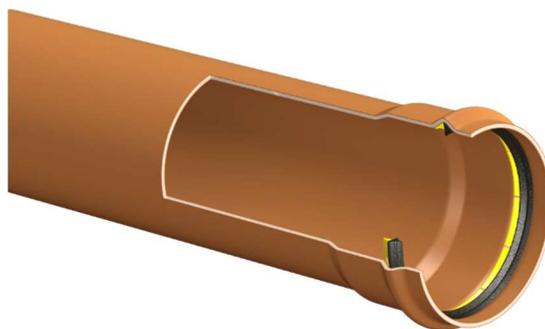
Труба из НПВХ безнапорная с усиленным уплотнительным кольцом
